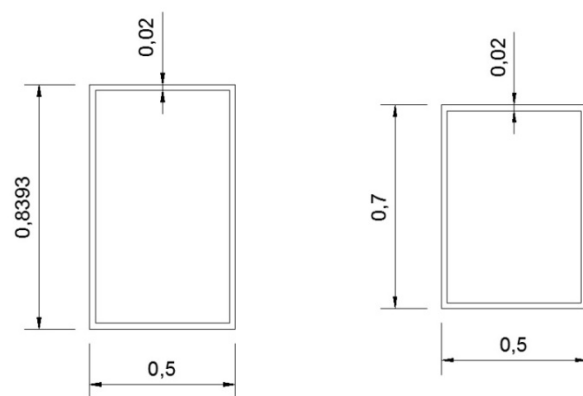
Figura V: SECCIONES CENTRO-LUZ Y ARRANQUE. VIGAS DE PISO
